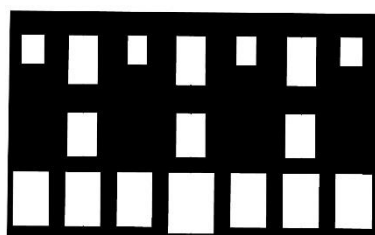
Estudo de aberturas na fachada sudeste do claustro.
